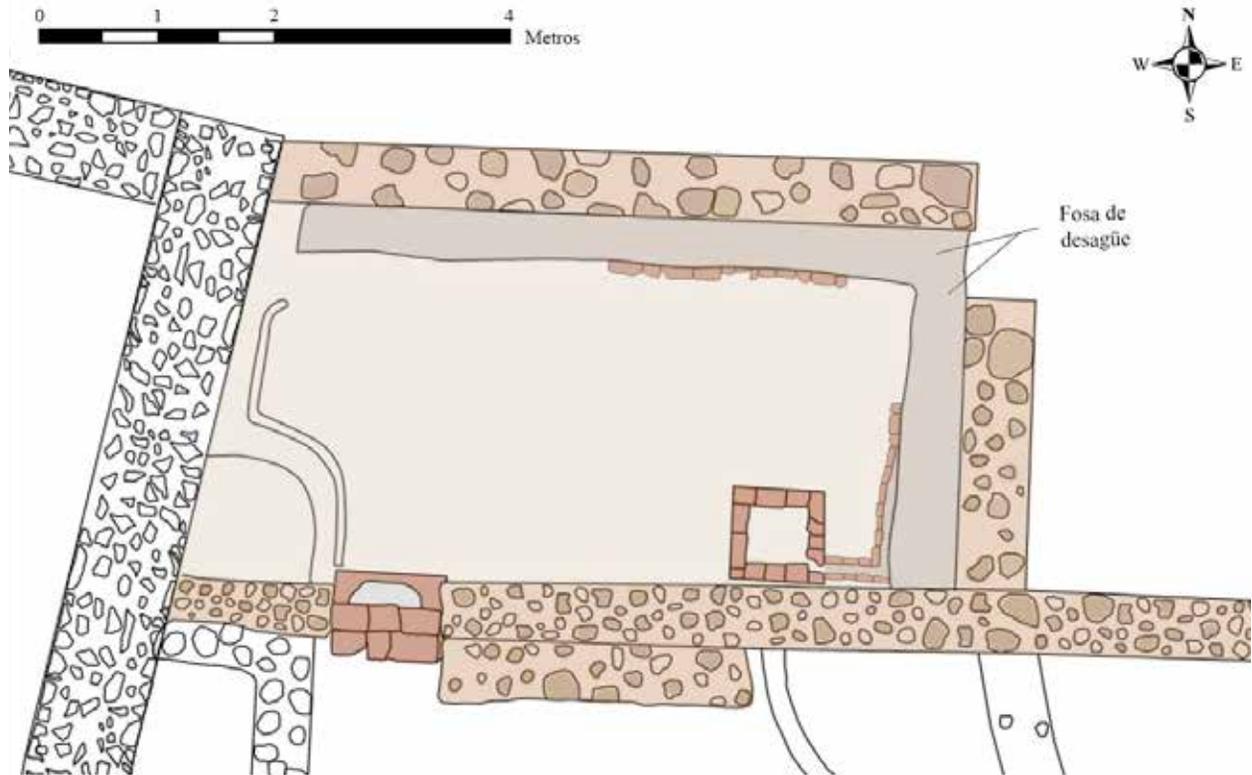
Reconstrucción planimétrica de las técnicas edilicias documentadas en el Sector III.
